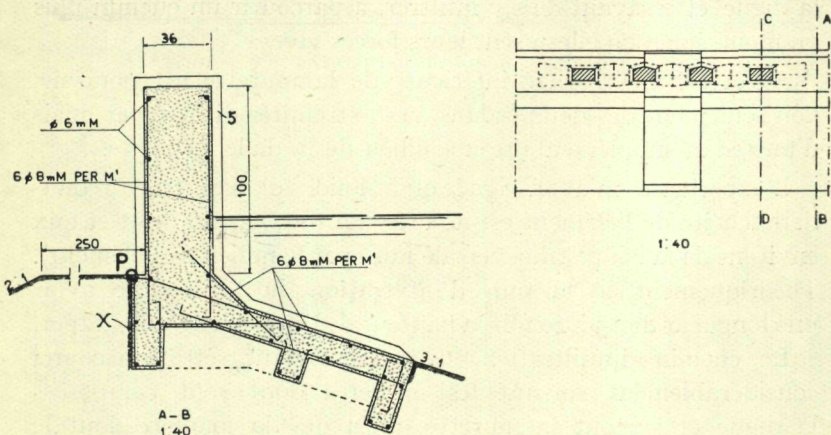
Coupe transversale A.B et coupe horizontale d'un élément de parapet en béton armé sur une digue de fleuve.
